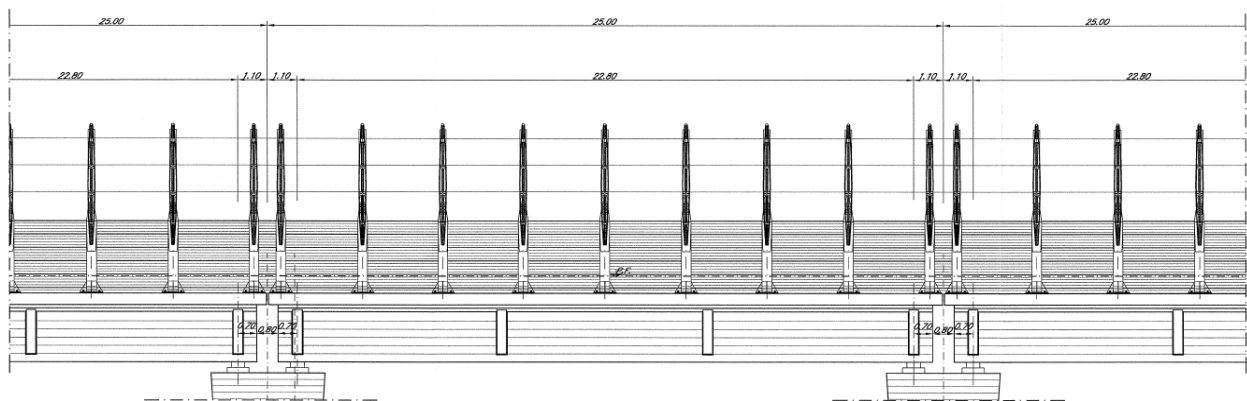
Prospetto tipo viadotto c.a.p. L=25.00m
